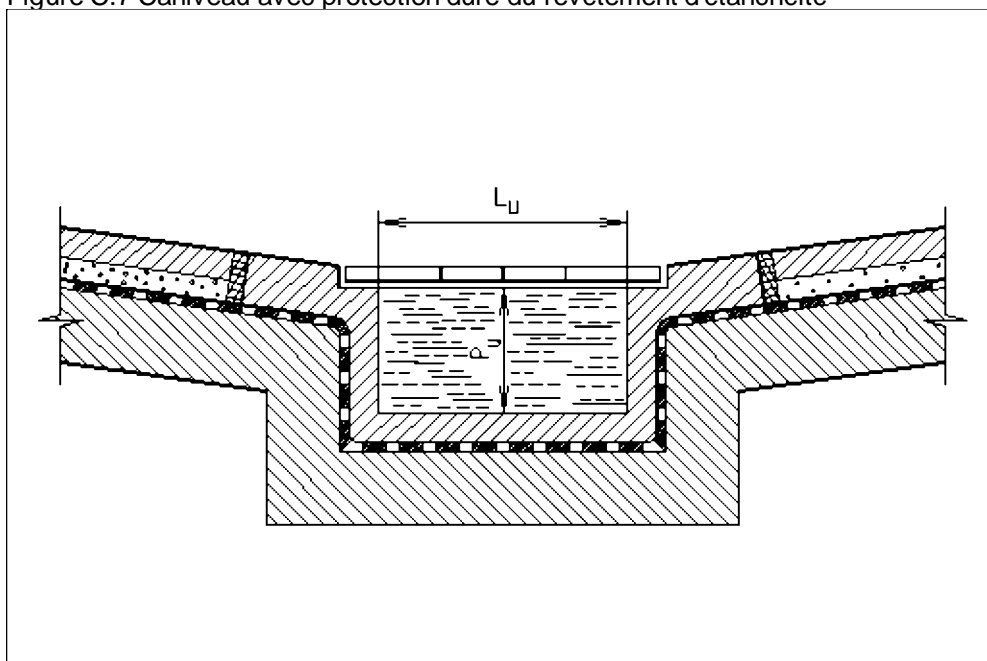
Caniveau avec protection dure du revêtement d'étanchéité
